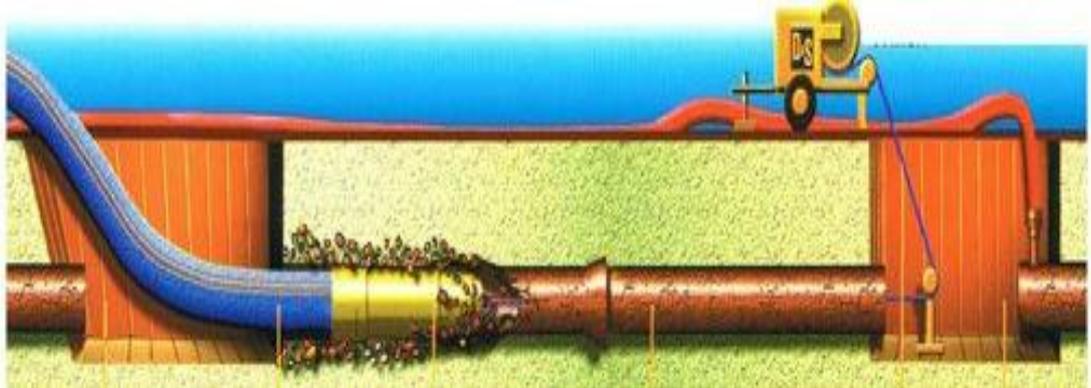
Proceso de colocación de una tubería, por el método de fractura de tubería.
